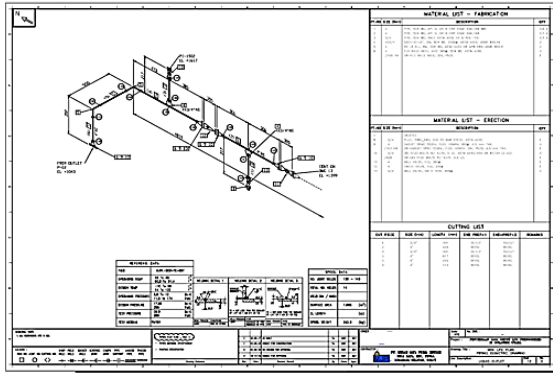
Mini LPG Plan Piping Isometric Drawing 1
